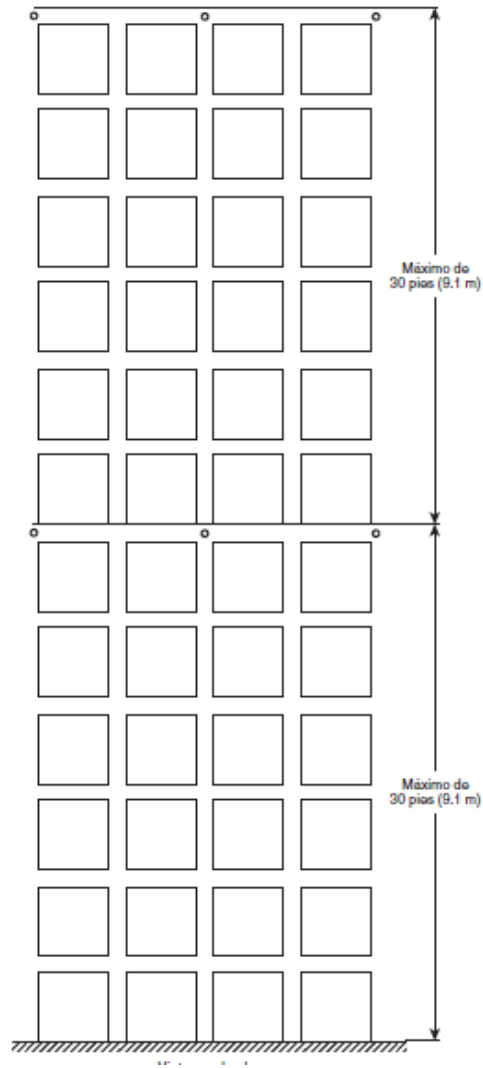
Protección con rociadores en estantería para plásticos en cajas de cartón en estanterías de hileras múltiples.
